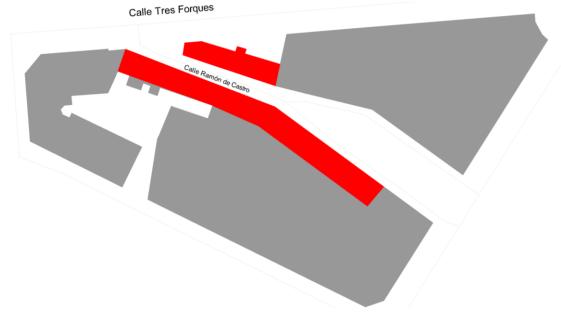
Plano de emplazamiento. En rojo, las viviendas Ramón de Castro. Fuente: Elaboración propia
